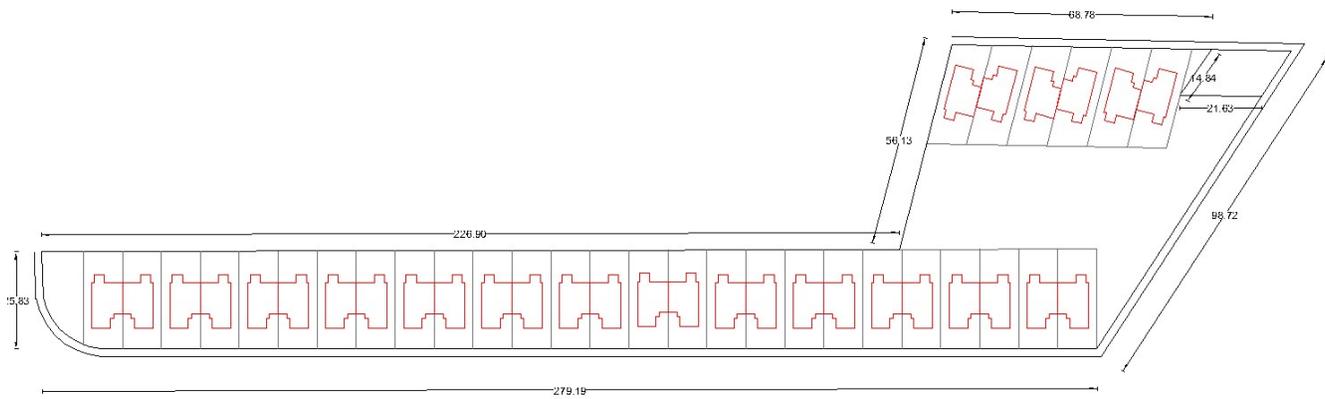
Planta del terreno con acomodo de casas. Fuente: Torres E.
